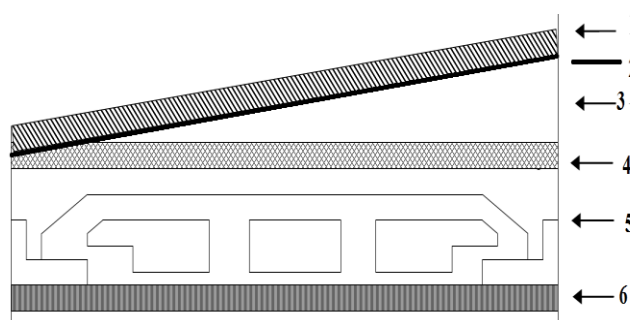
Schéma statique de Plancher terrasse inaccessible
